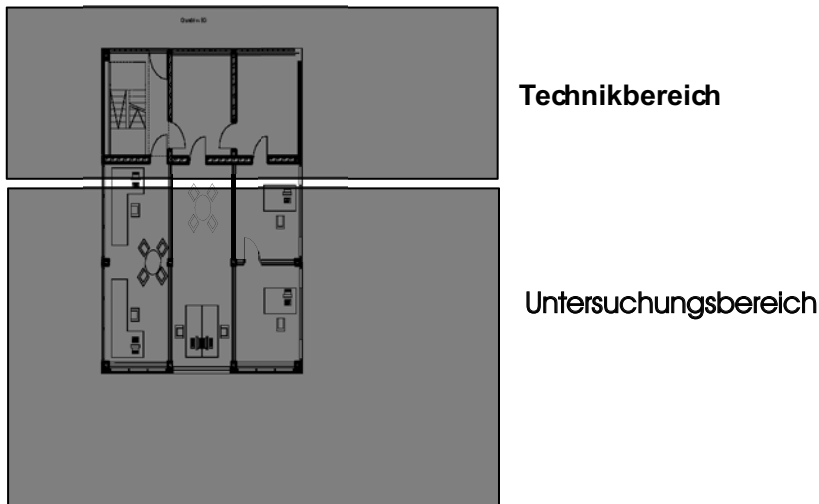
Grundriss einer Etage mit Technikbereichen und den für die Versuche nutzbaren Untersuchungsbereichen.
